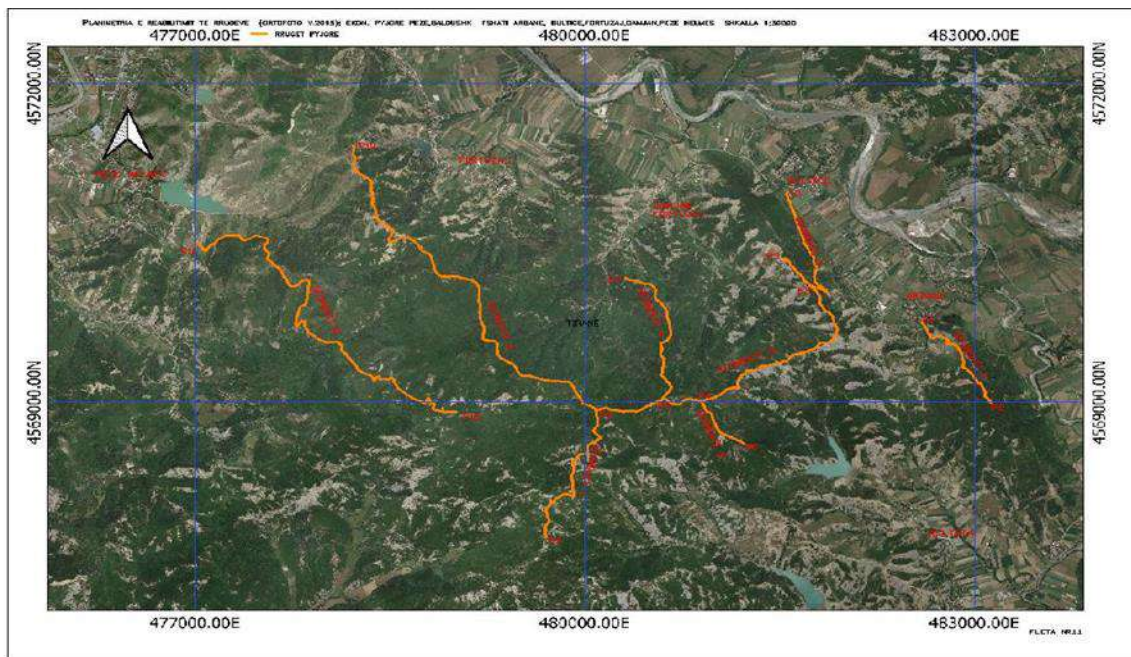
Planimetria e rrugës në ortofoto të gjeoreferuar
